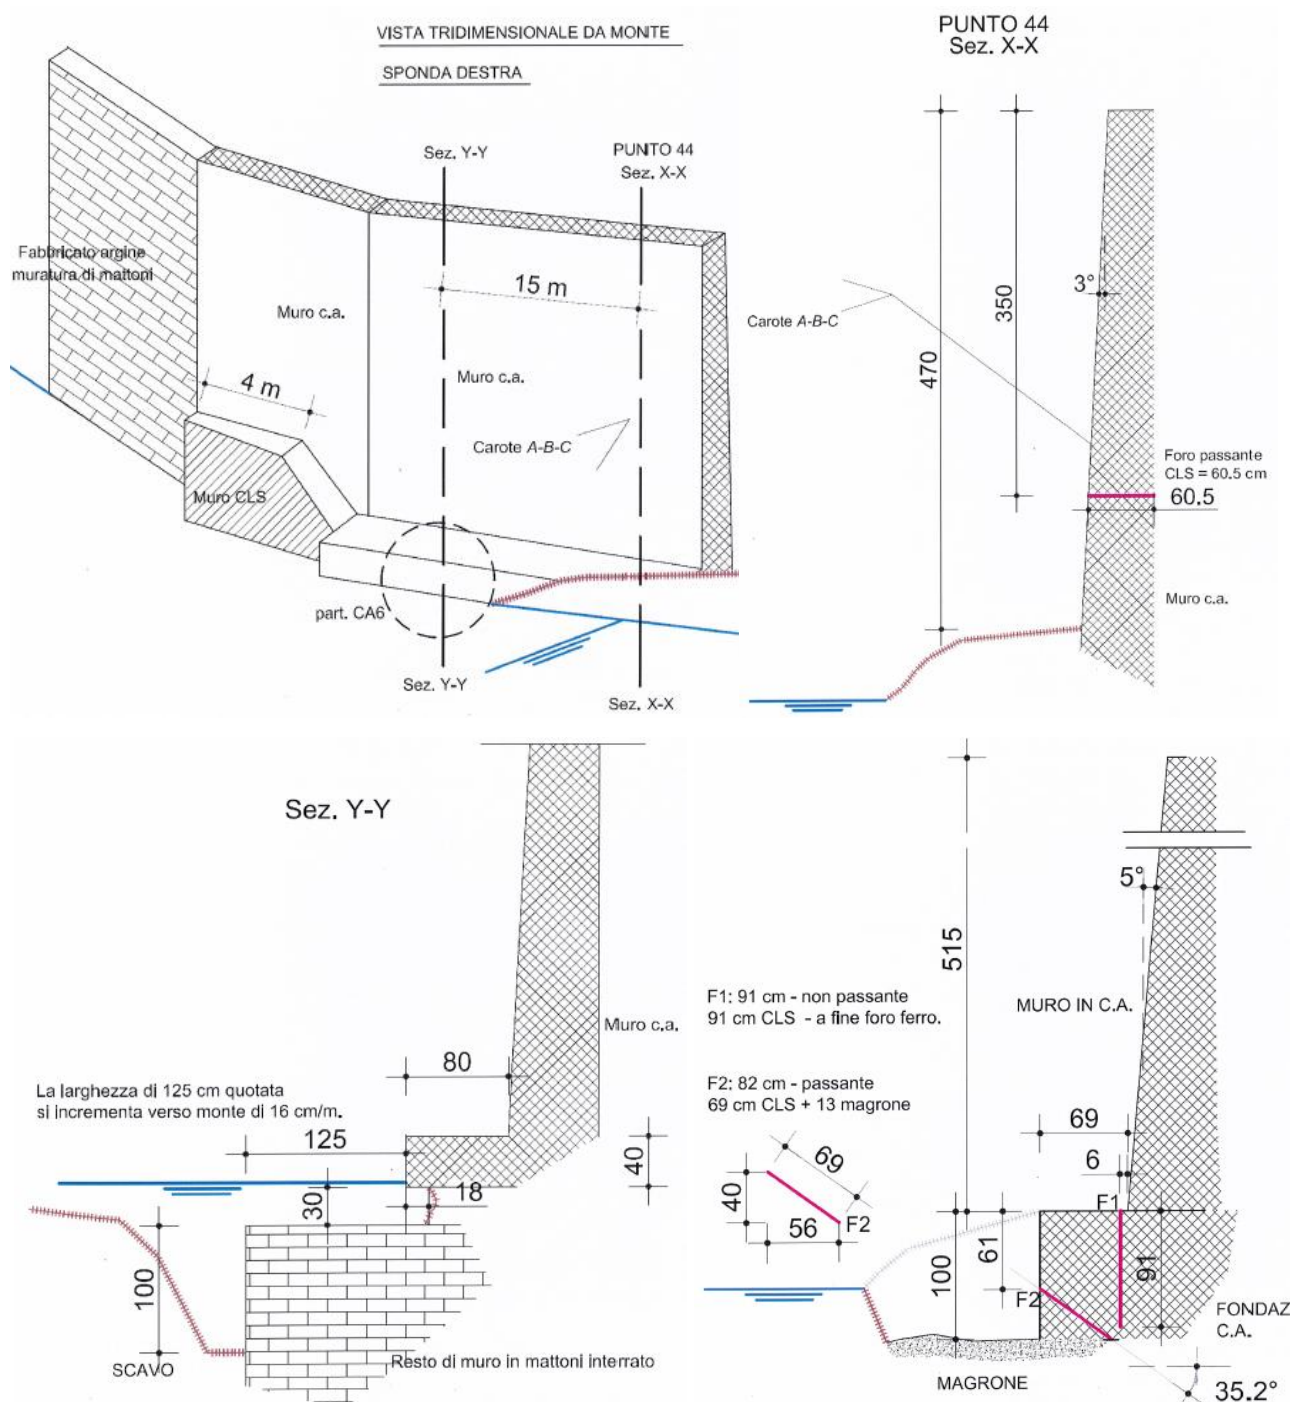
Sezione tipologica strutturale rilevata in sito
